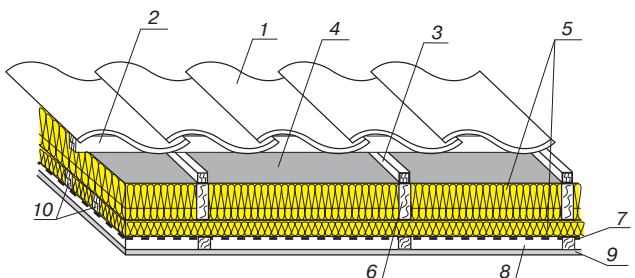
Конструкция с несущим каркасом, расположенным в холодной зоне: 1 – кровельное покрытие; 2, 3, 10 – контробрешетка; 4 – гидроизоляционная паропроницаемая мембрана Tyvek Soft; 5 – теплоизоляция ISOVER СкатнаяКровля; 6 – стропила; 7 – пароизоляция; 8 – воздушный зазор; 9 – внутренняя отделка мансарды;
